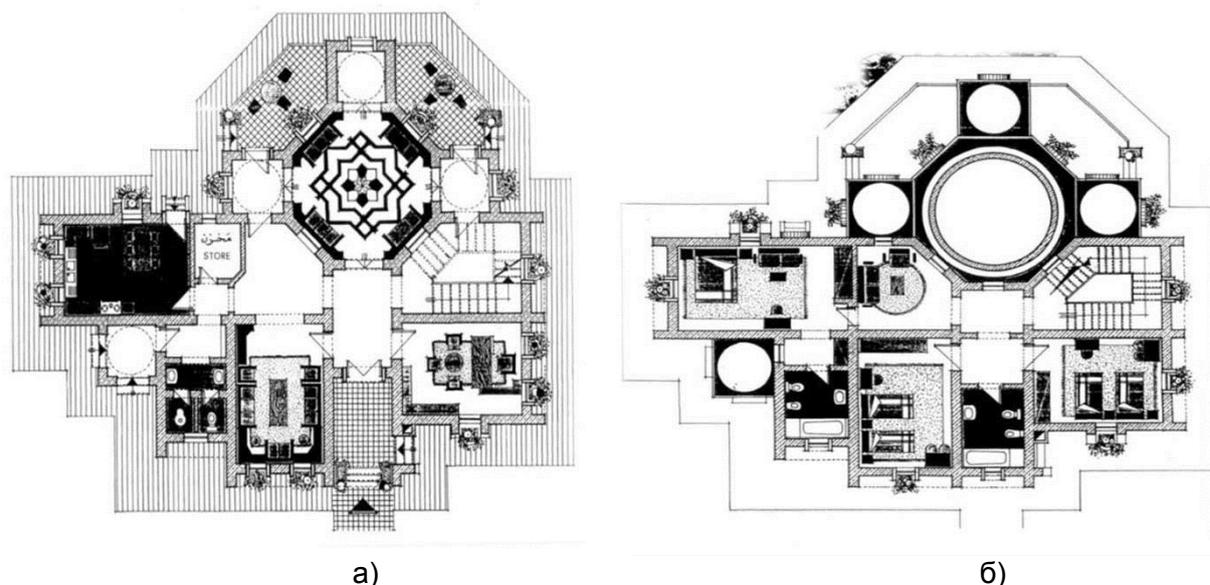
Одноквартирное МЖЗ с садом (для арабов). Семья из 8 человек: а) план 1-го этажа; б) план 2-го этажа (рисунки автора)
